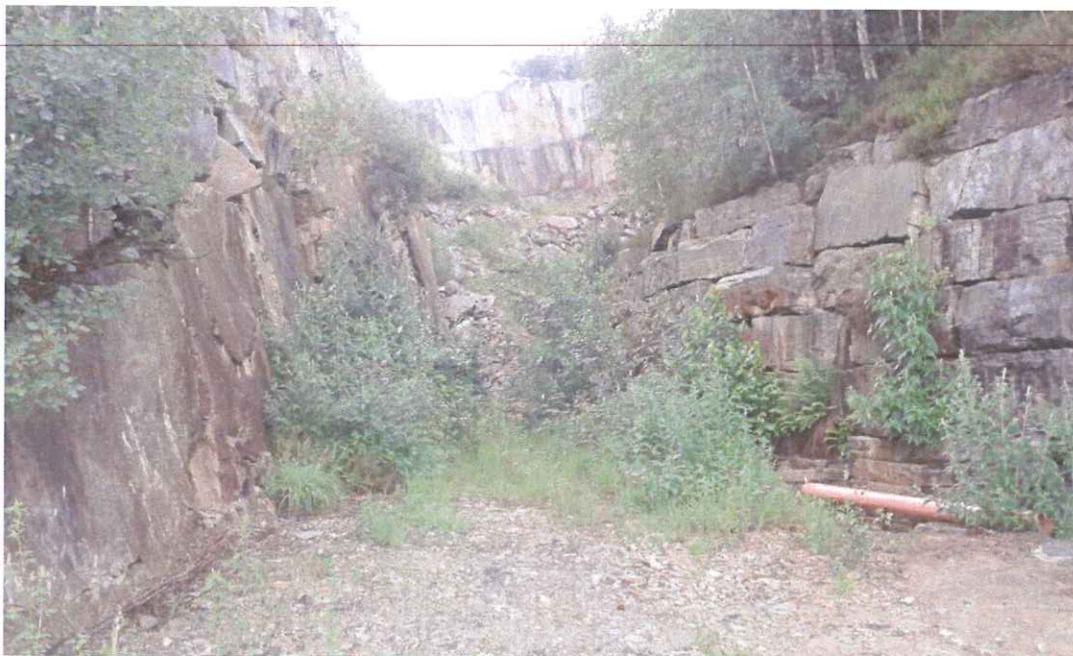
la "trincea" di collegamento con l'attività estrattiva posta a est
